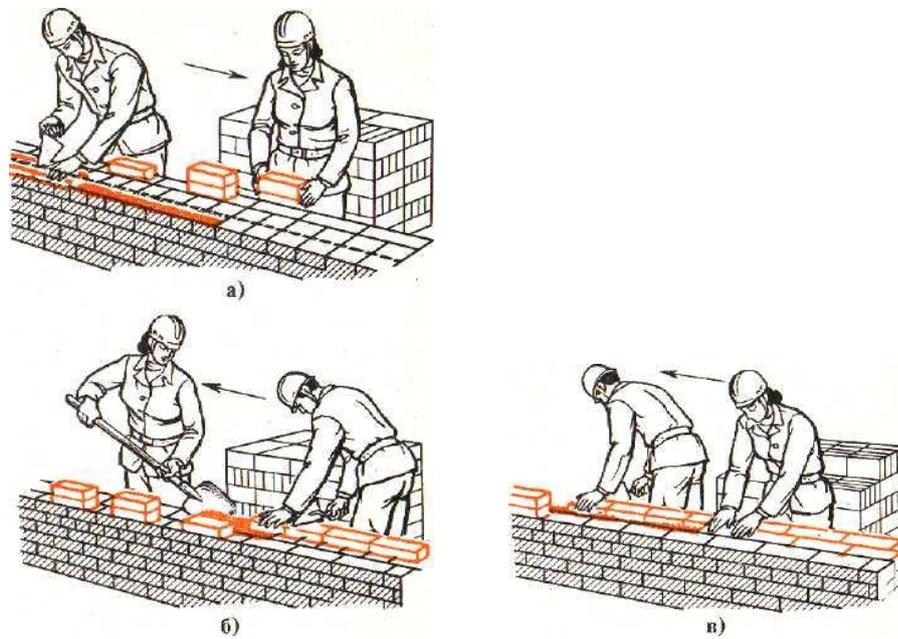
Кладка стены толщиной 1½ кирпича звеном «двойка»:
